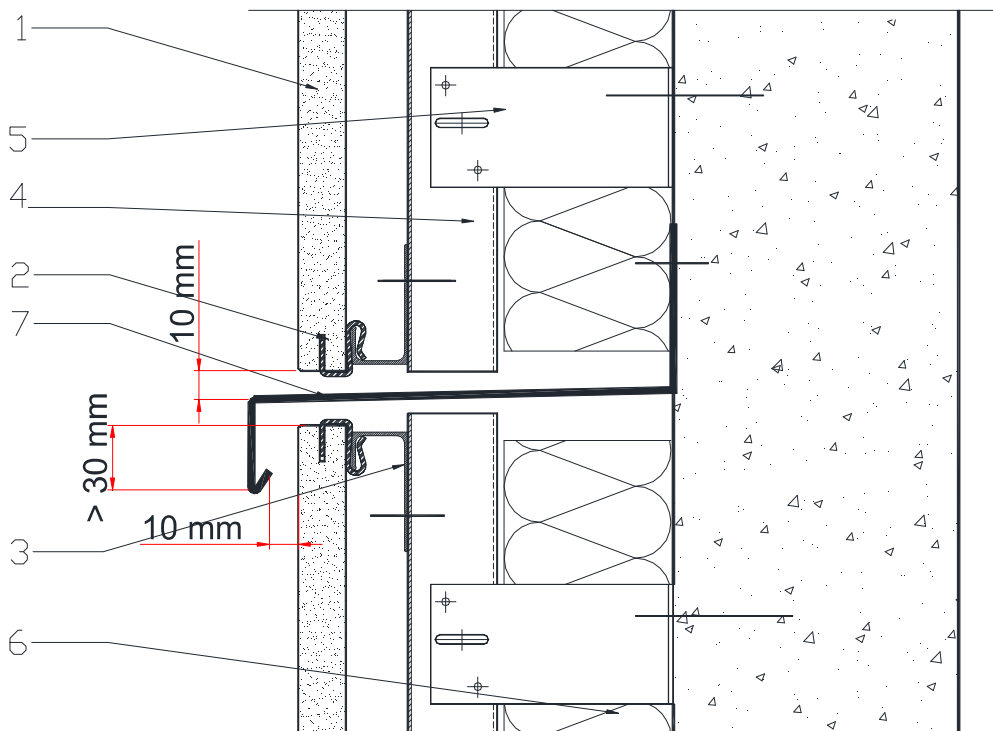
Fractionnement de la lame d'air pour des plaques de hauteur < 1 m
